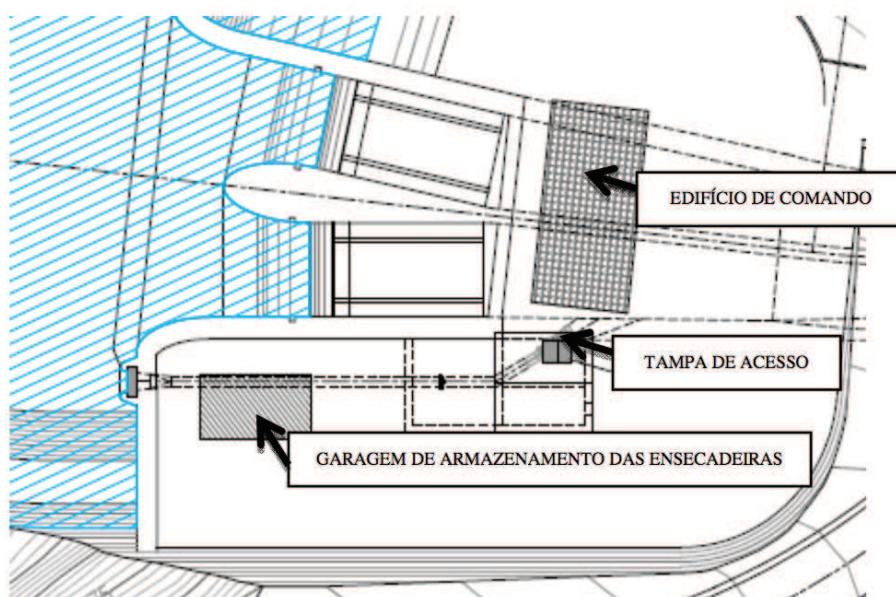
Planta do dispositivo de caudal ecológico [31]
